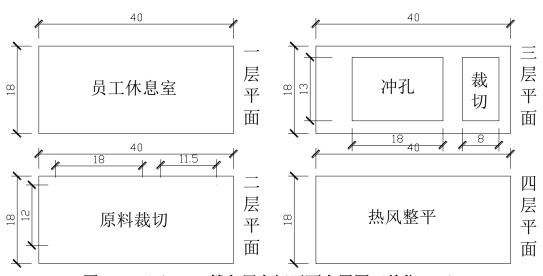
(d) 4#楼各层车间平面布置图(单位: m)
